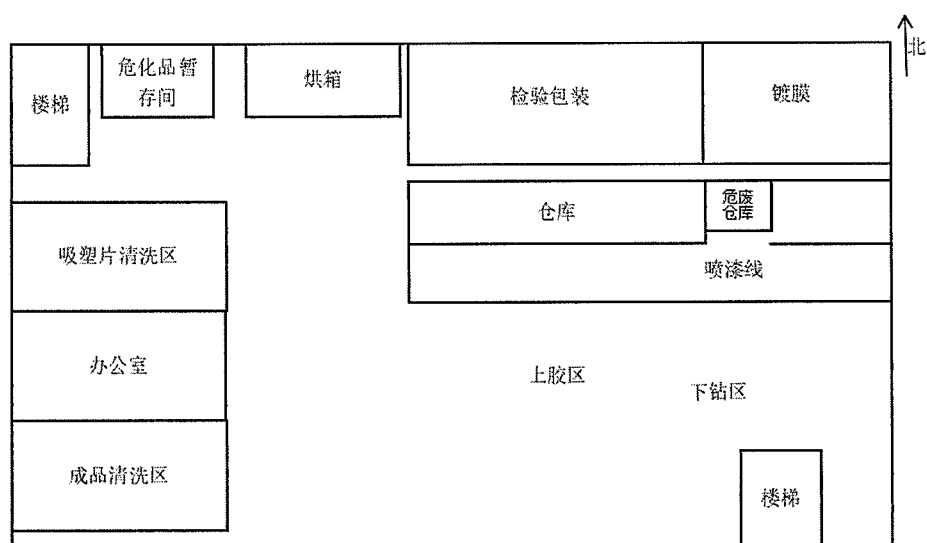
项目总平面布置图 (2#厂房 3 楼)
